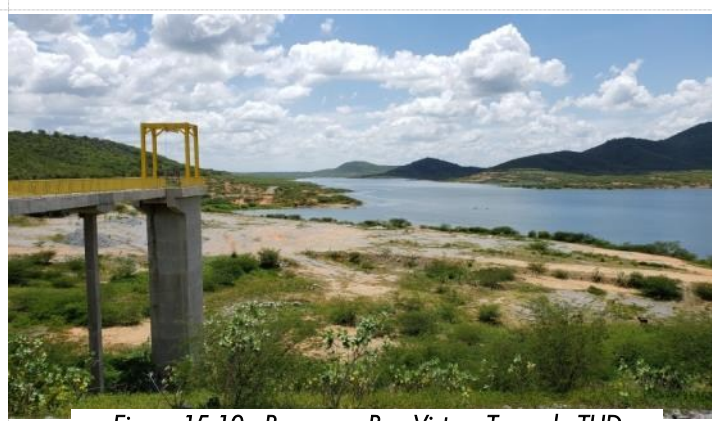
Barragem Boa Vista – Torre da TUD
